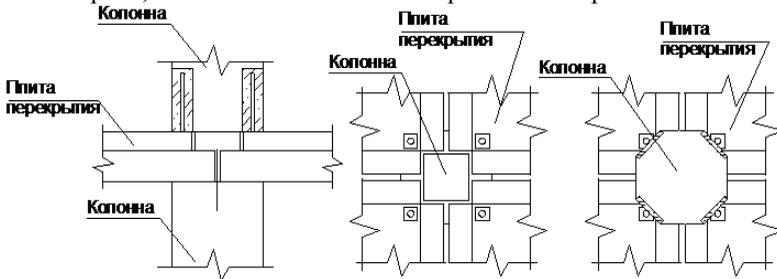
Узел сопряжения колонн с колоннами и плитами перекрытия
